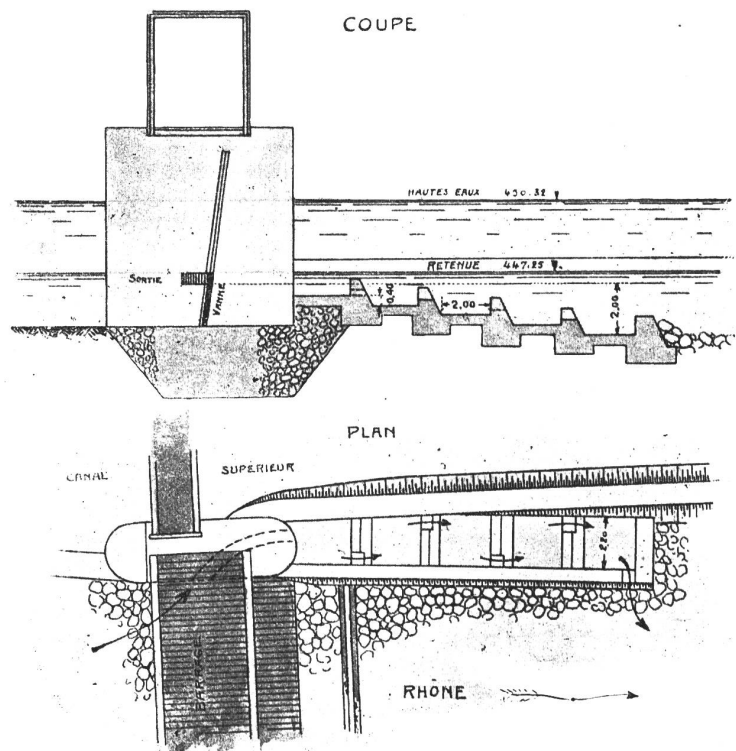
Barrage de l'usine de St-Maurice. Plan et coupe de l'échelle à poissons. Maßstab 1 : 300.
